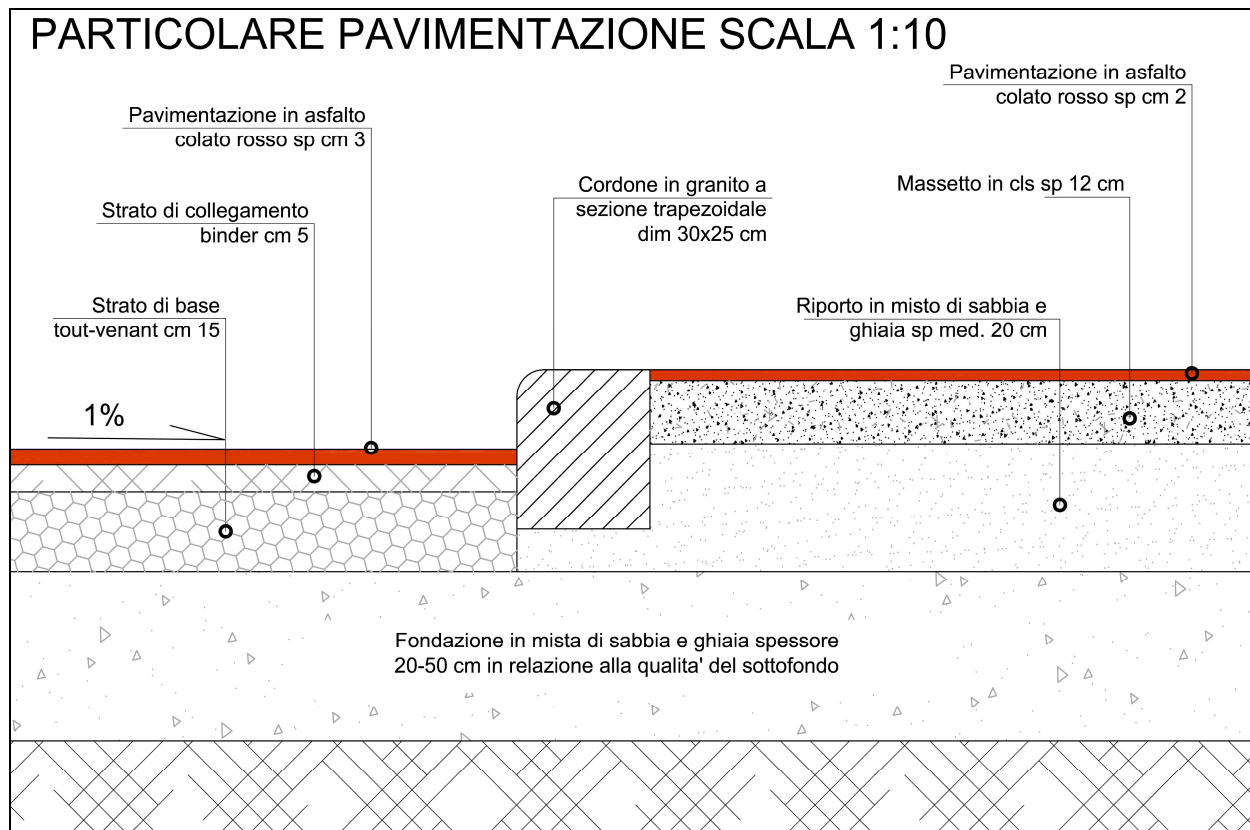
Particolare pavimentazioni pacchetto stradale e marciapiede
